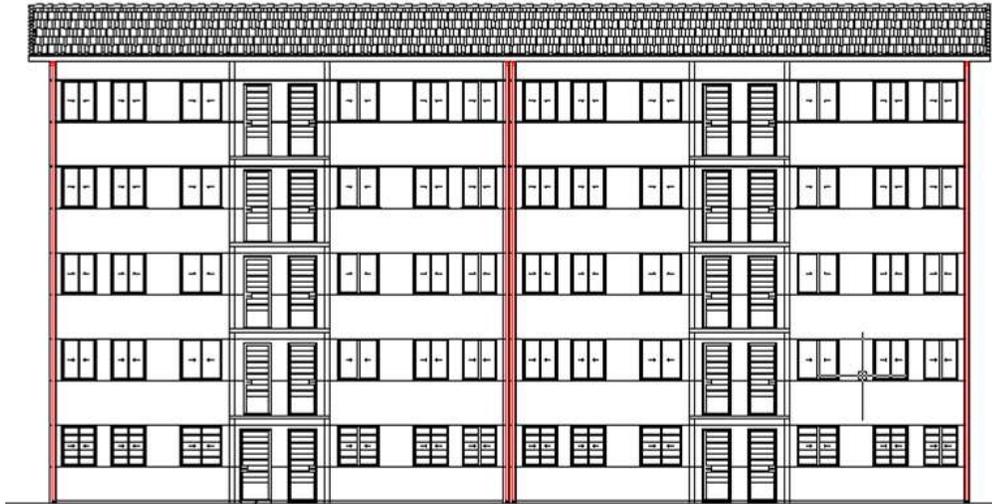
Elevação de um edifício, um pavimento térreo e 04 andares, sem elevador com duas escadas – estão localizadas em frente as portas de entrada (fonte: projeto arquitetônico da CDHU)
